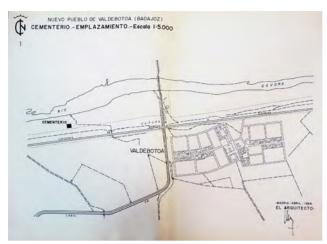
Emplazamiento del cementerio de Valdebótoa.
